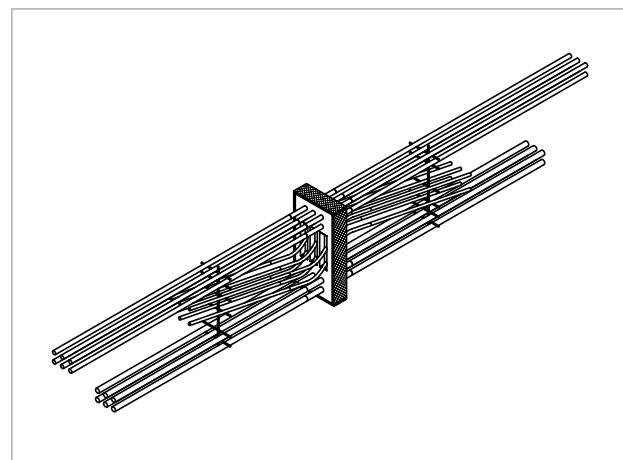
Schöck Isokorb® T Type B : Panneaux de protection incendie sur tout le pourtour
